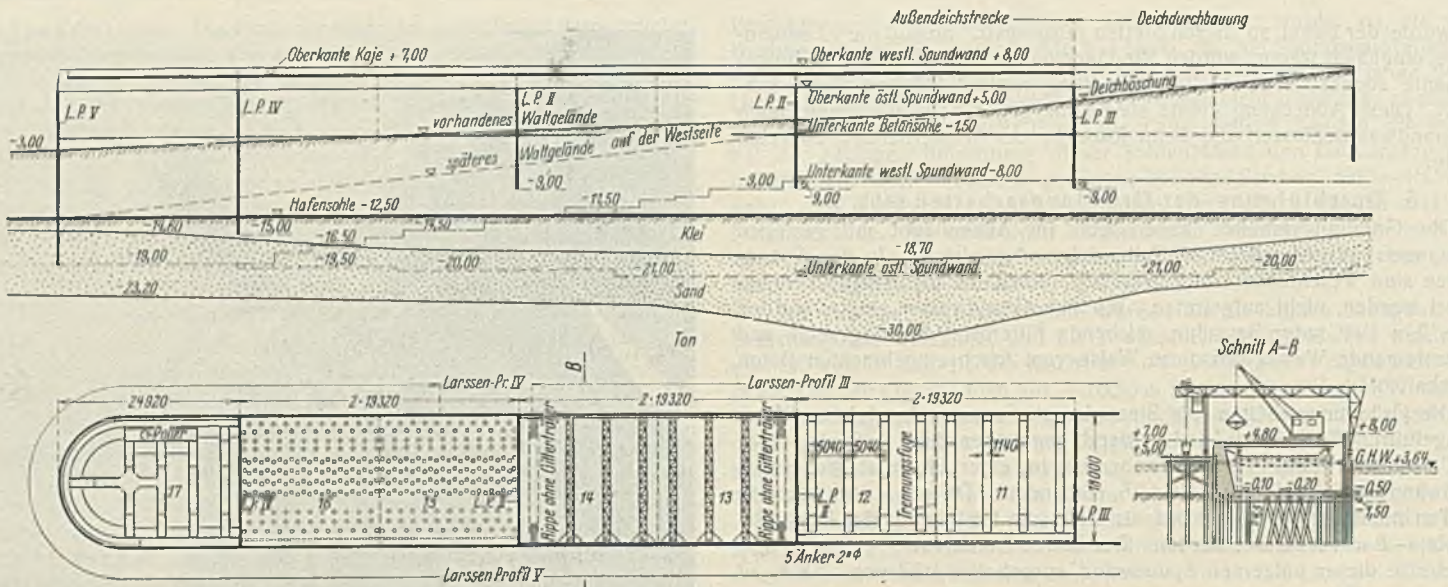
Molenstrecke außerhalb des Wasserdeiches.
